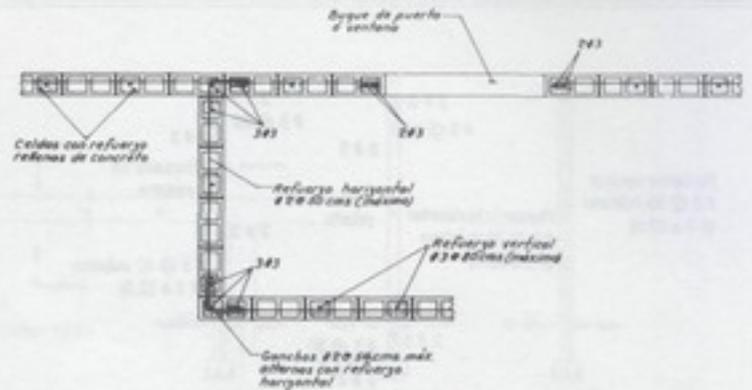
Sección típica de pared mampostería con refuerzo integral.
